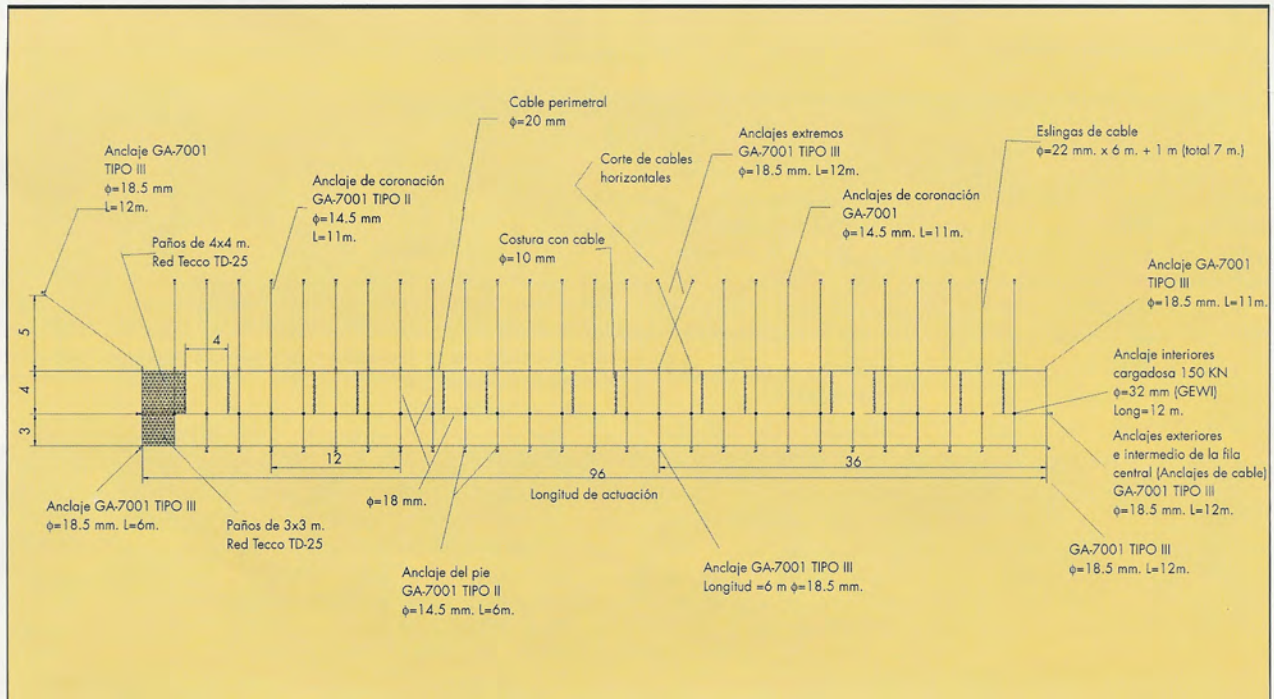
Desarrollo en planta de la solución de refuerzo.
